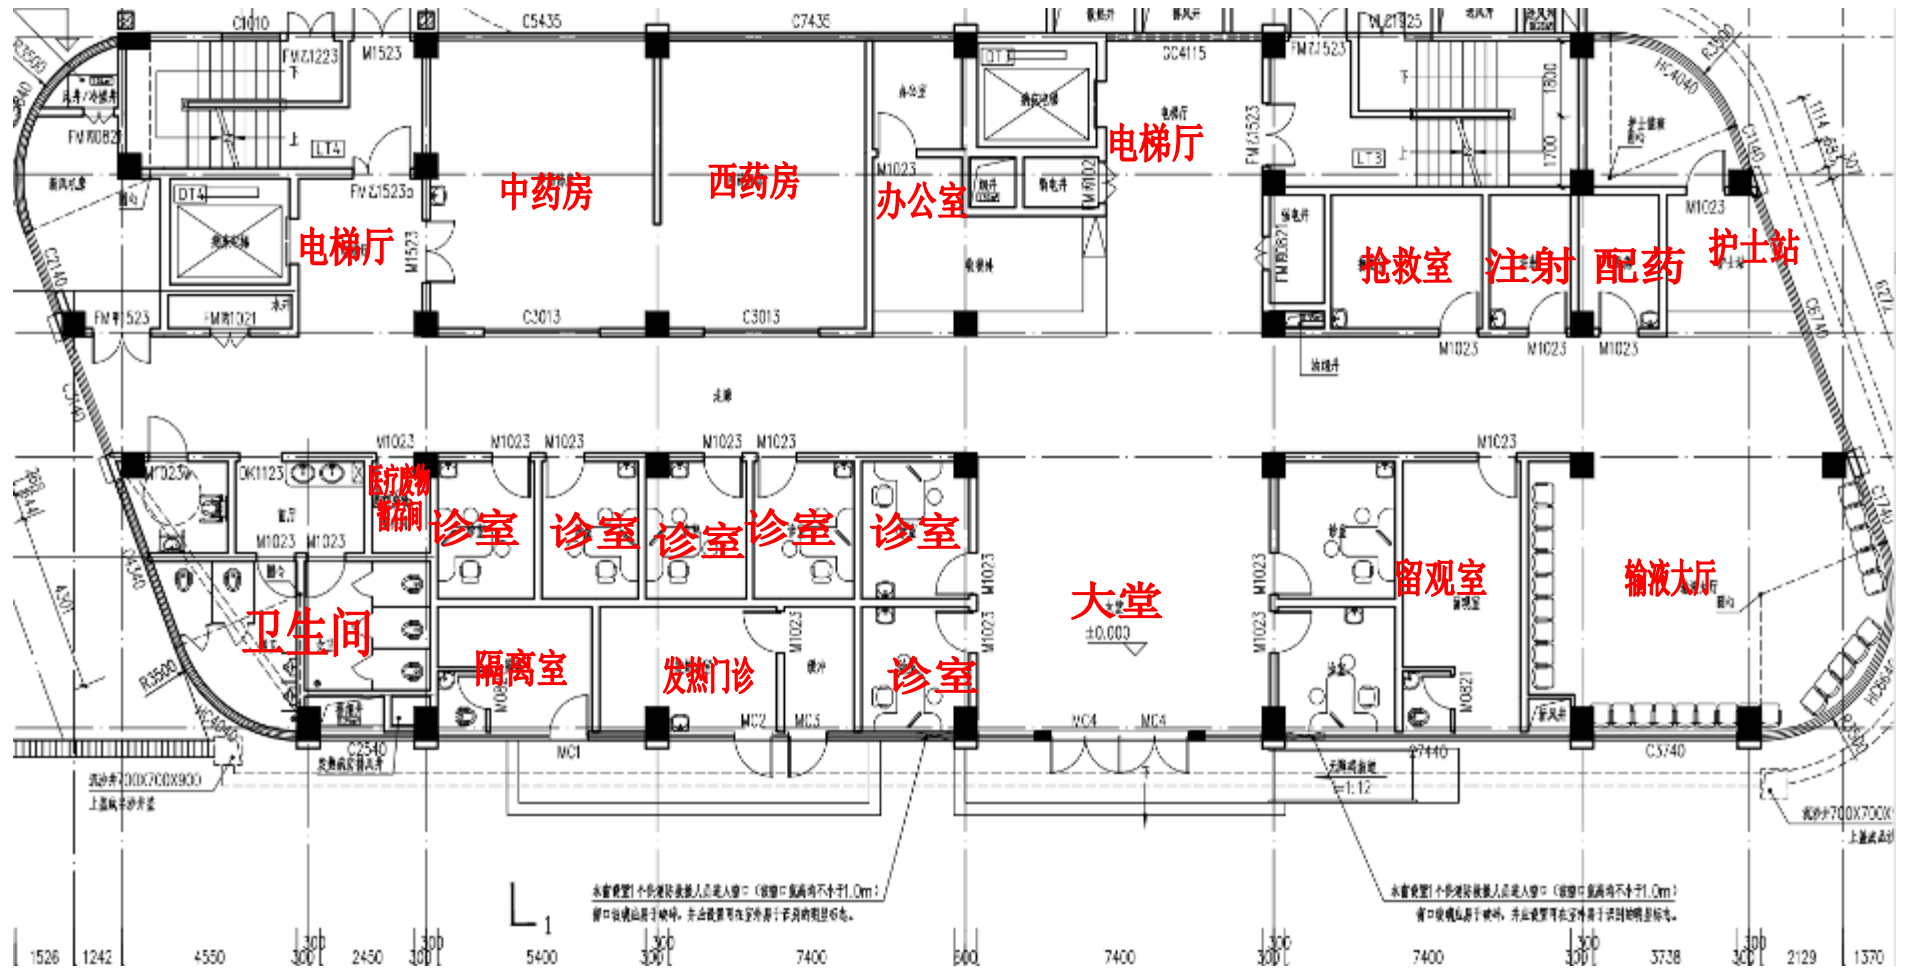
项目第二社区卫生服务中心大楼一层平面图
